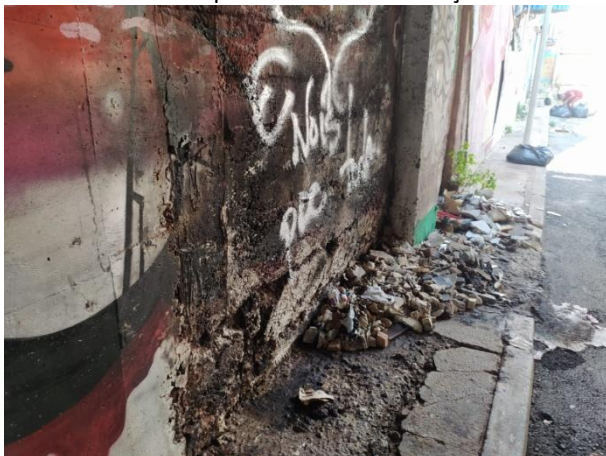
Vista do pilar e da laje da passarela Oeste
